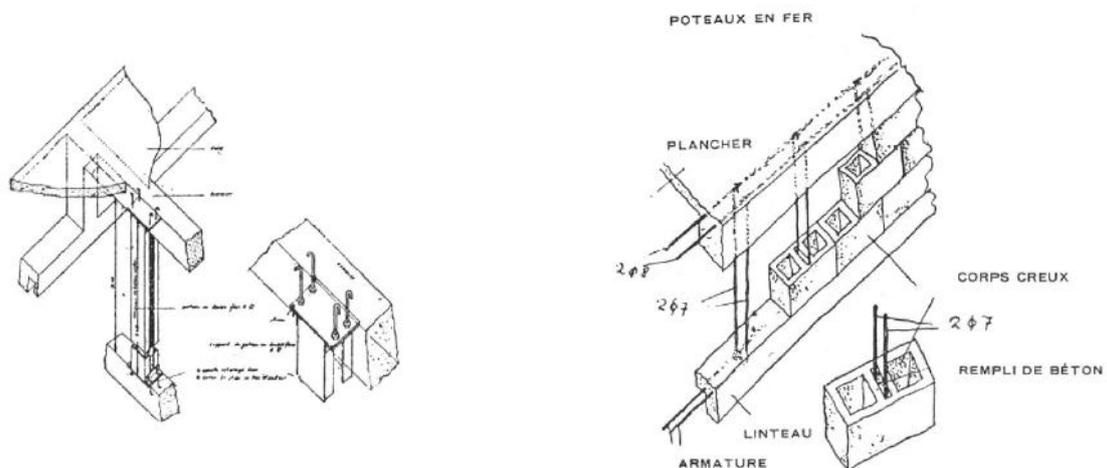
Detalles del dintel colgado del forjado de cubierta.
